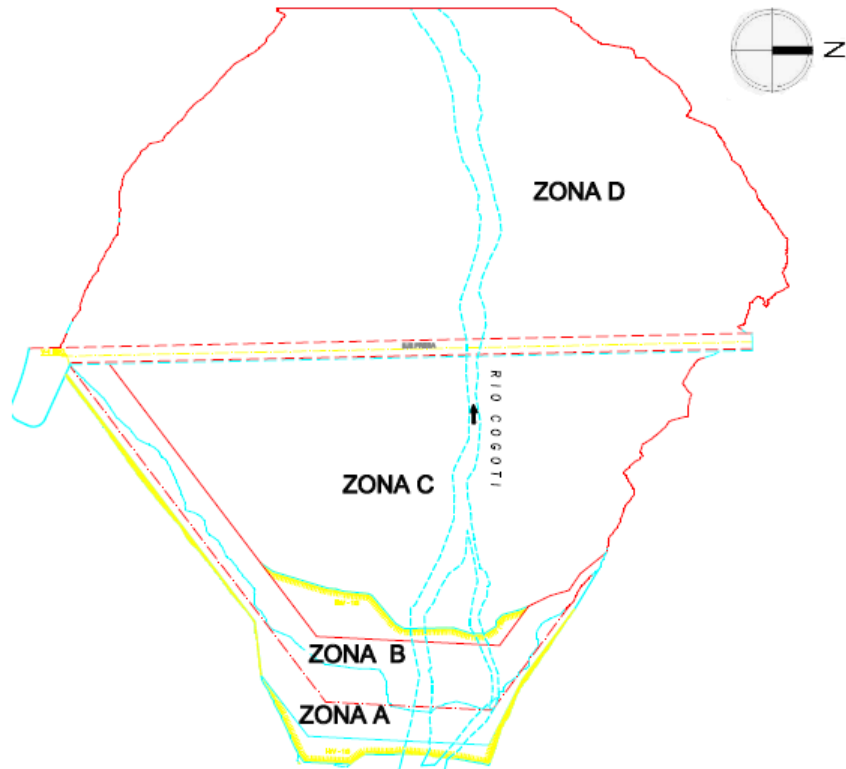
Planta excavaciones fundación presa; Fuente: DOH.
